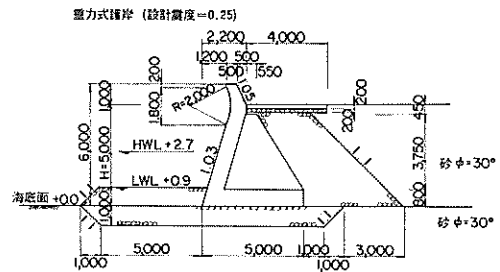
重力式護岸の標準断面図 (設計震度 = 0.25)
